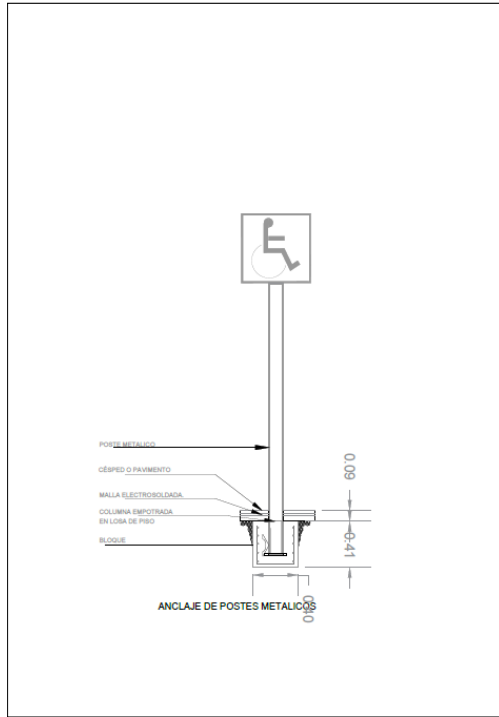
, Detalle técnico constructivo de los anclajes de los postes metálicos.
